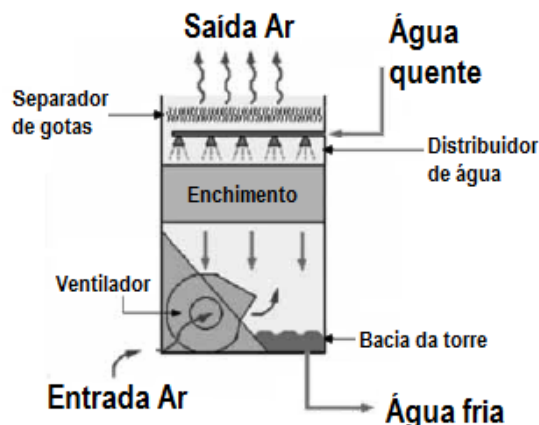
Constituição esquemática da torre de arrefecimento
